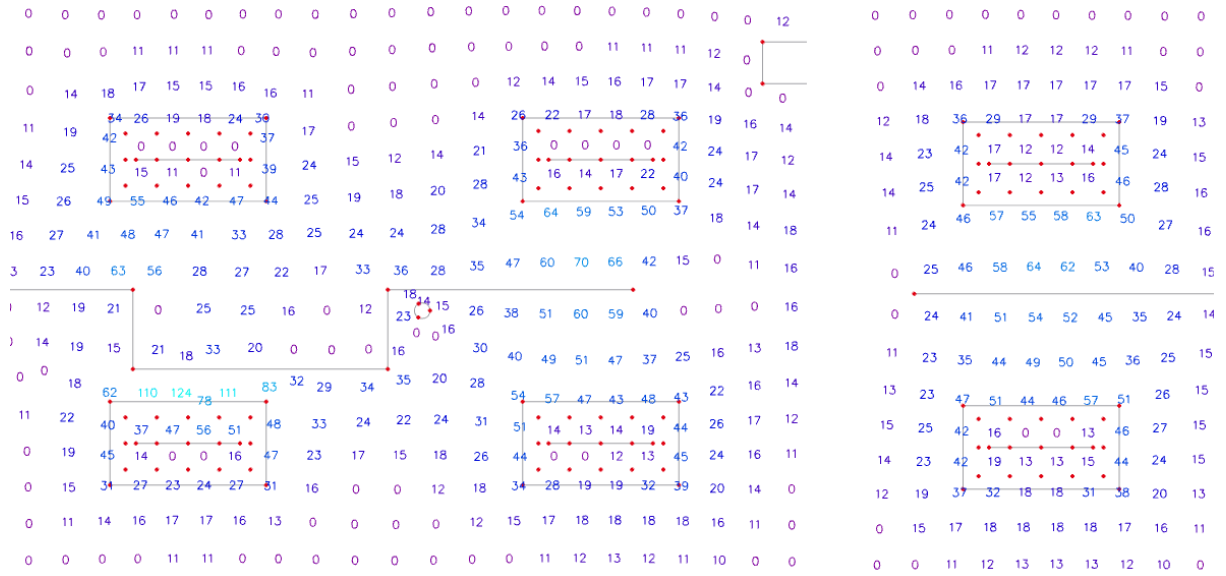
Nutná horní výztuž ve směru Y rovnoběžném s osou trámu [cm²/m]
